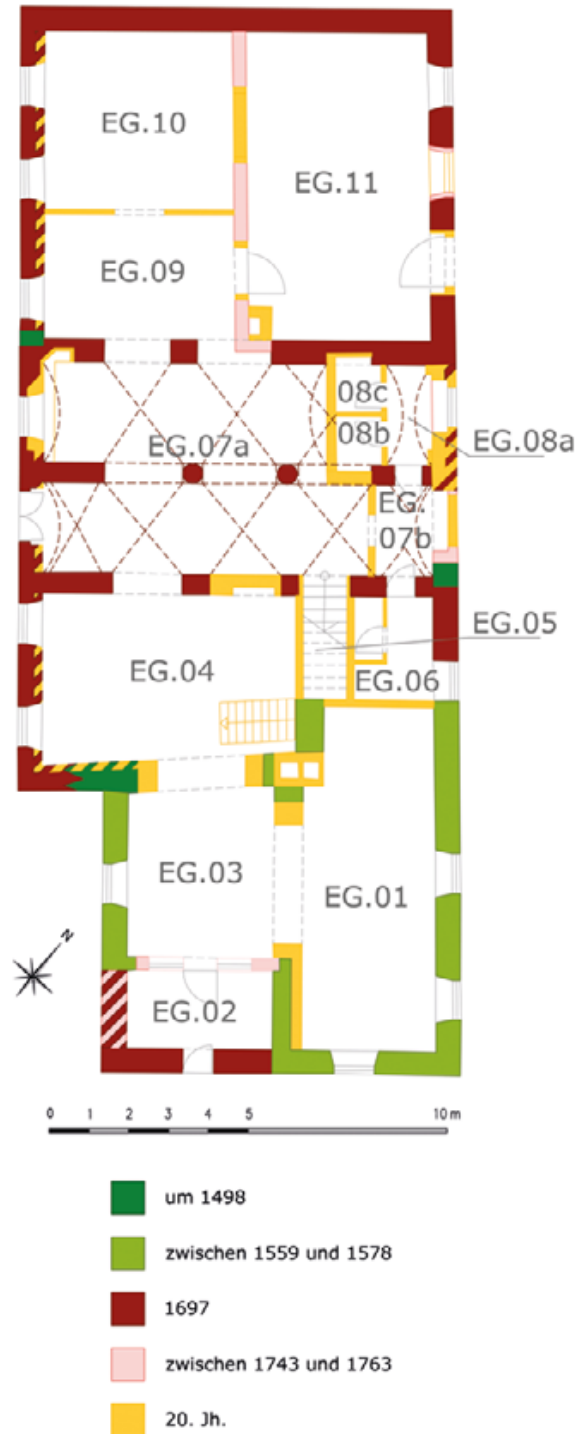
Grinzling, Badhaus. Bualterplan des Erdgeschoßes.
